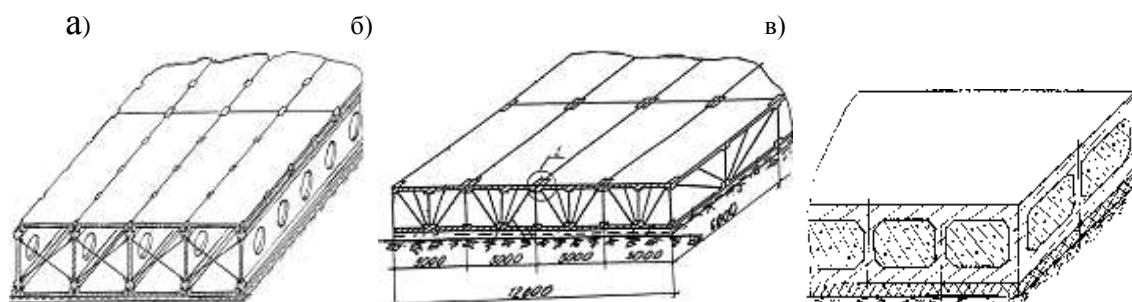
Пространственные фундаментные платформы для строительства на слабых и вечномёрзлых грунтах и в сейсмических районах: *а)* сборная железобетонная платформа (патент РФ № 38789); *б)* сборная сталежелезобетонная фундаментная платформа (патент РФ № 2206665); *в)* монолитная фундаментная платформа с утеплителем (патент РФ № 45410).
